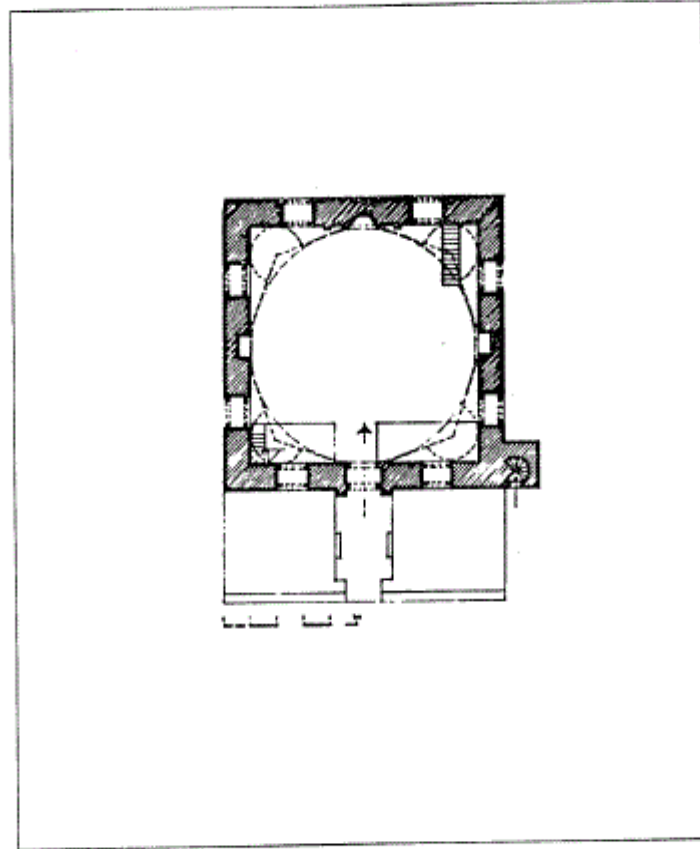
مسقط أفقي لدار الحديث في أدرنة (عن : اصلان ابا) .
